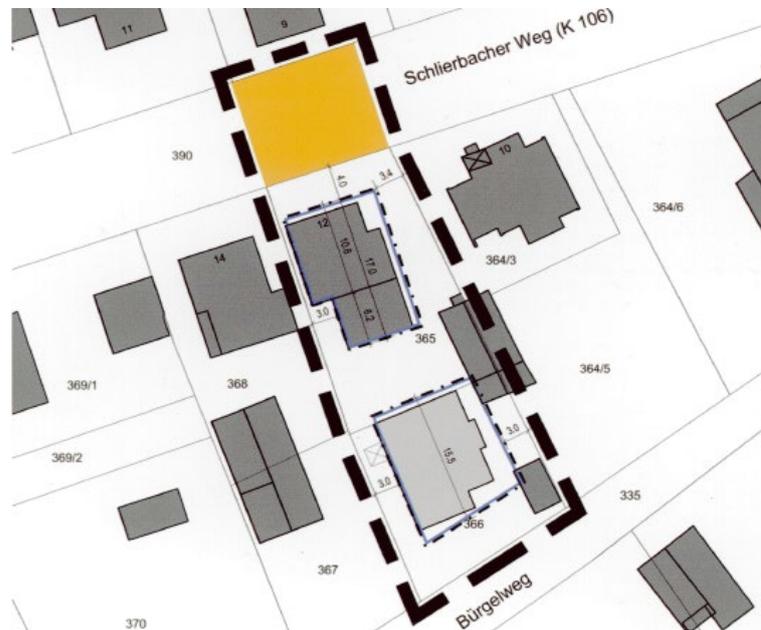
Ausschnitt des Bebauungsplans "Schlierbacher Weg 12"
